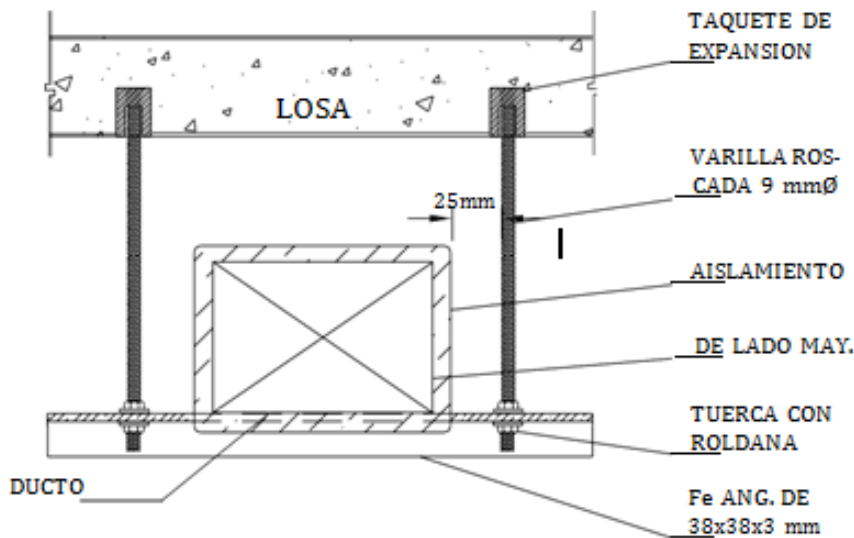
Detalle de aislamiento de ducto exterior.
